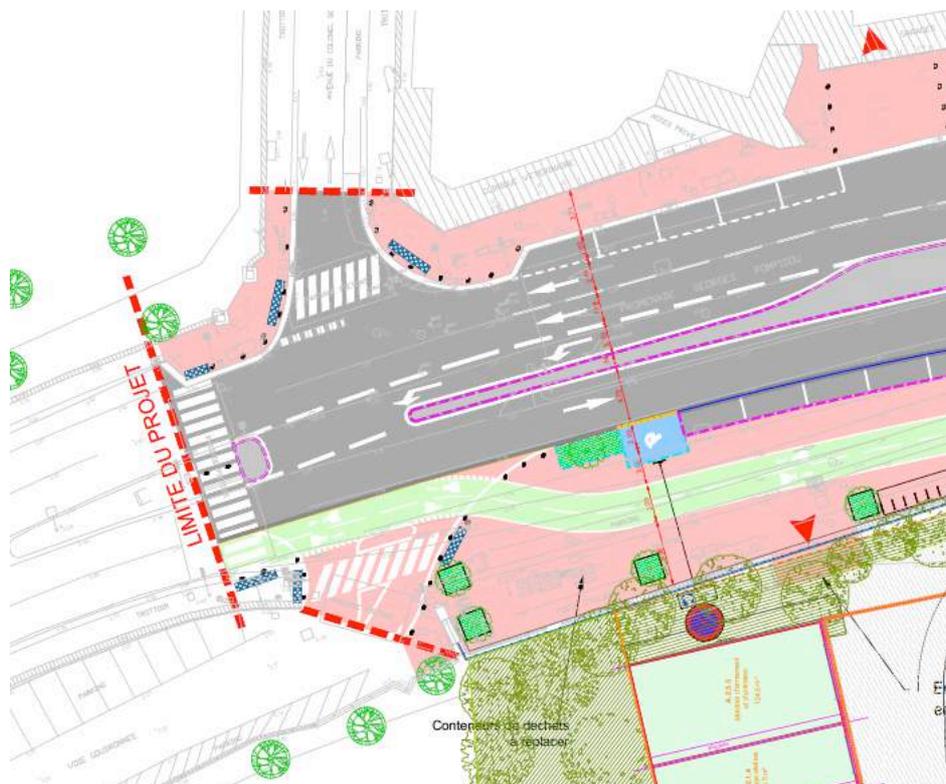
VUE EN PLAN CARREFOUR AVEC L'AVENUE DU COLONEL SEROT
